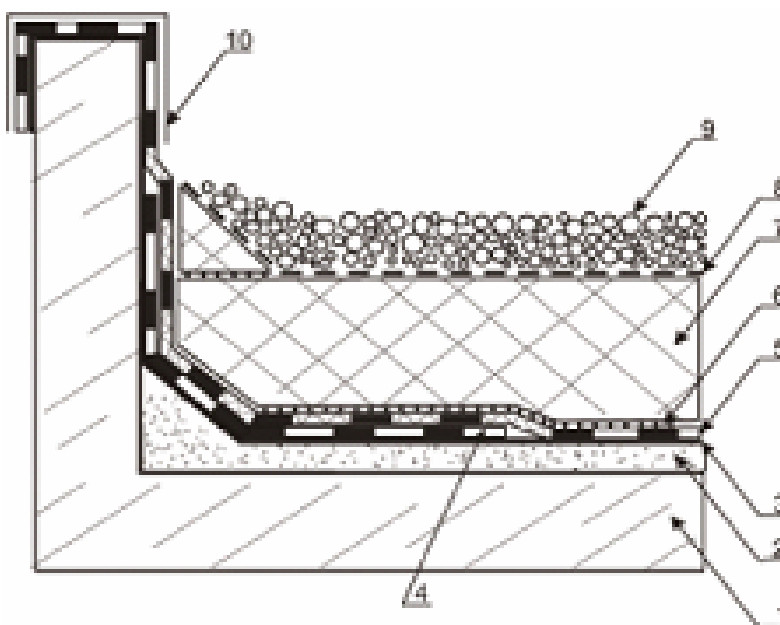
Примыкание кровли к парапету для инверсионной кровельной системы (Неэксплуатируемое покрытие)
